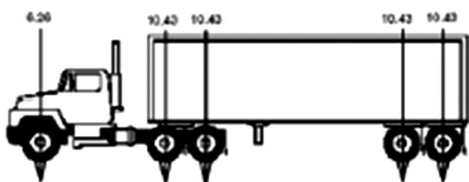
Camión tipo C3-S2, con las cargas por eje en toneladas
